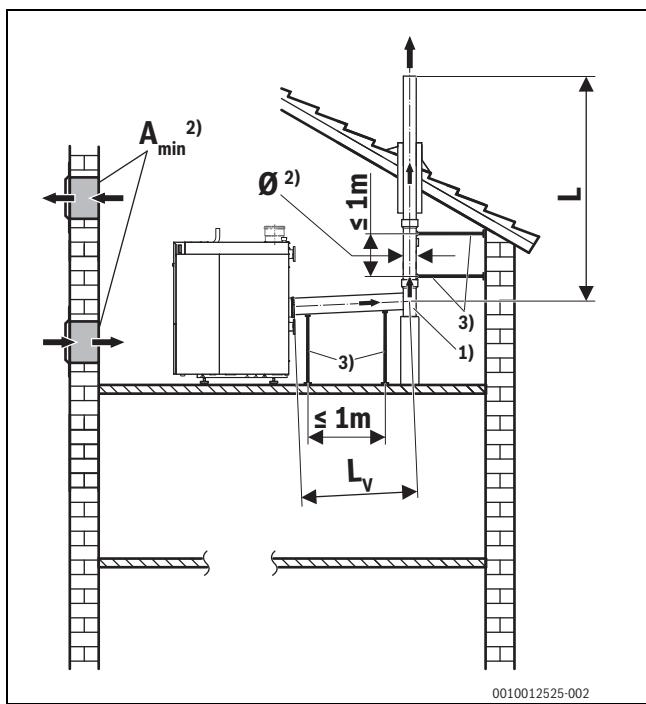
Abgasführung ohne Schacht, Dachzentrale, Variante 3
